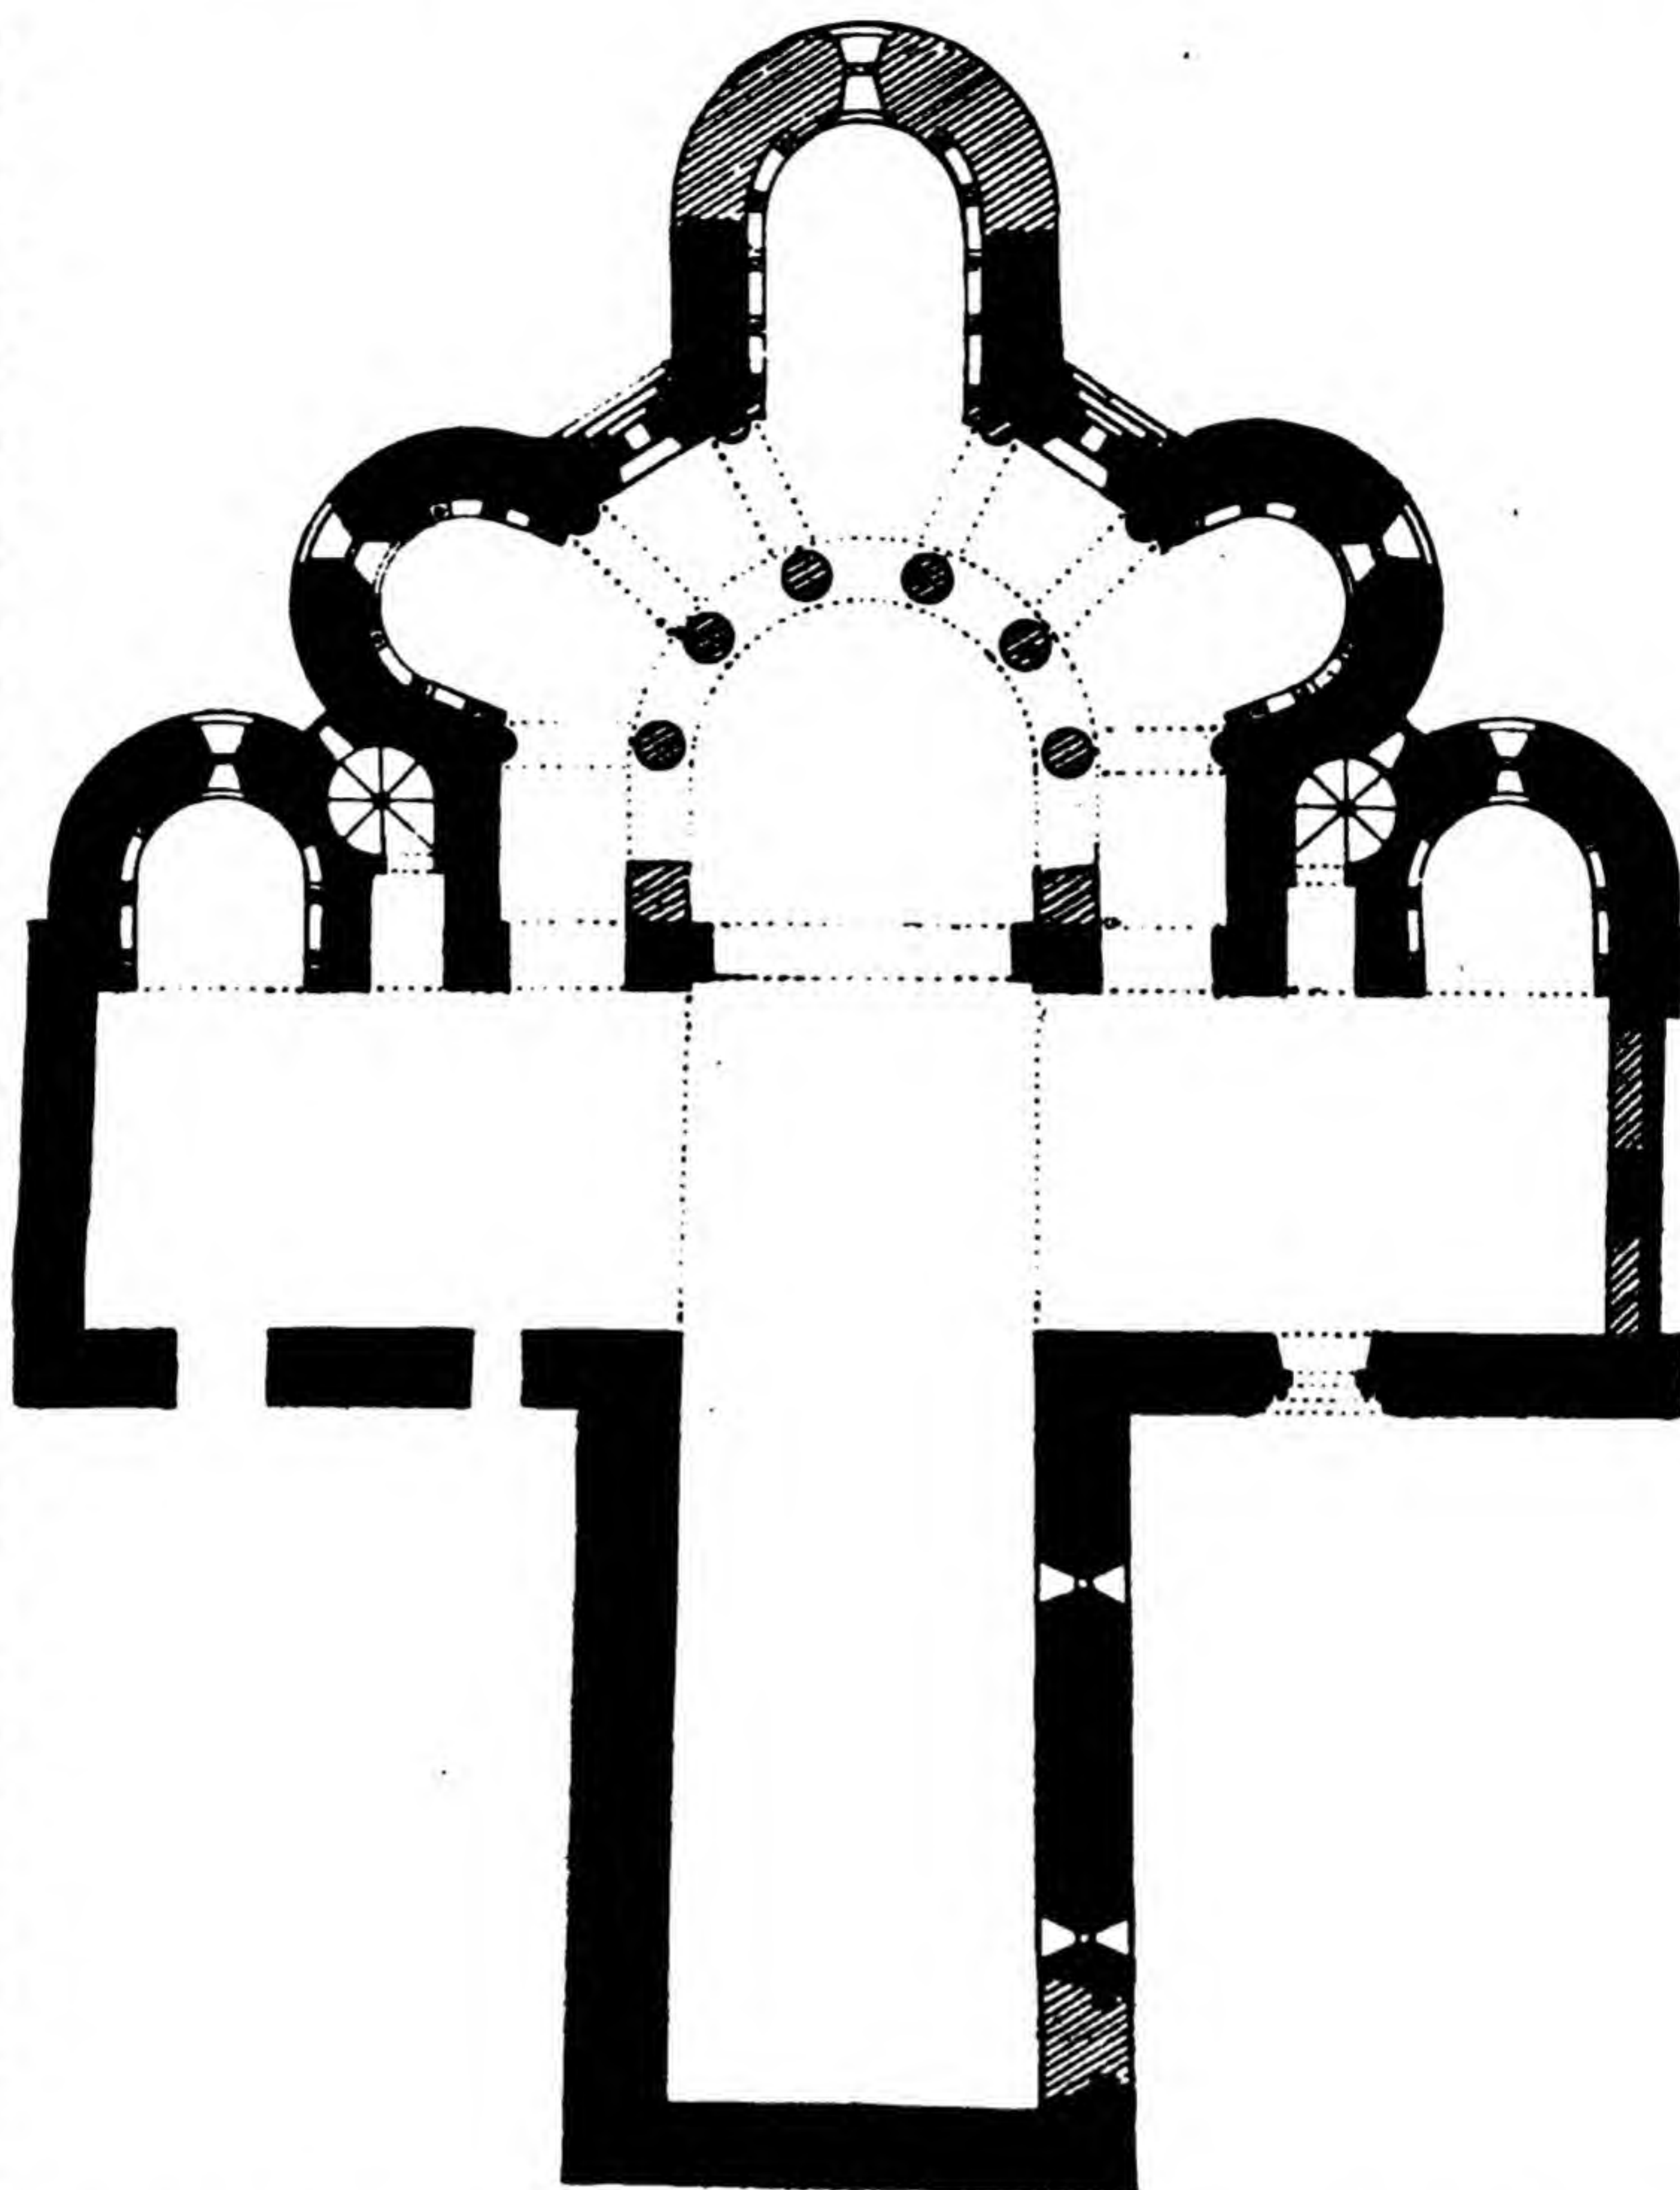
Plan de Sant Joan de les Abadeses. Restauració ideal Esc. 1:400
